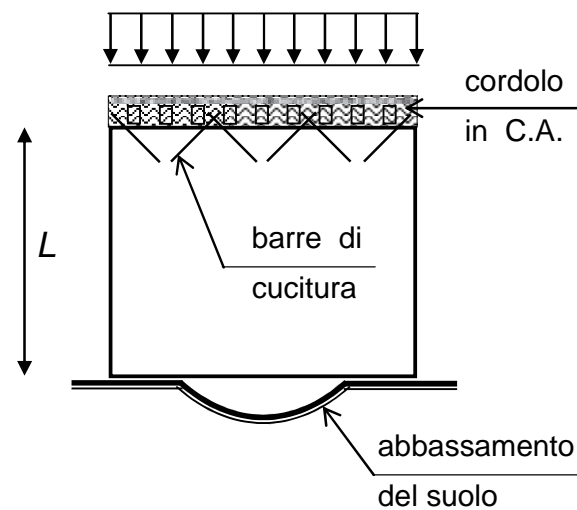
f. La conseguenza sfavorevole del cordolo nel caso di cedimenti del muro alla base può essere ridotta ai minimi termini collegando il cordolo alla sommità del muro, anziché limitarsi ad adottare la sommità del muro come mero fondo del cassero. Un ulteriore beneficio deriva dagli accorgimenti per interdire l'uscita dei paramenti dal loro piano (nastro in composito, intonaco armato, etc.). Tali accorgimenti debbono essere adottati a prescindere dall'abbassamento differenziale della striscia centrale.
